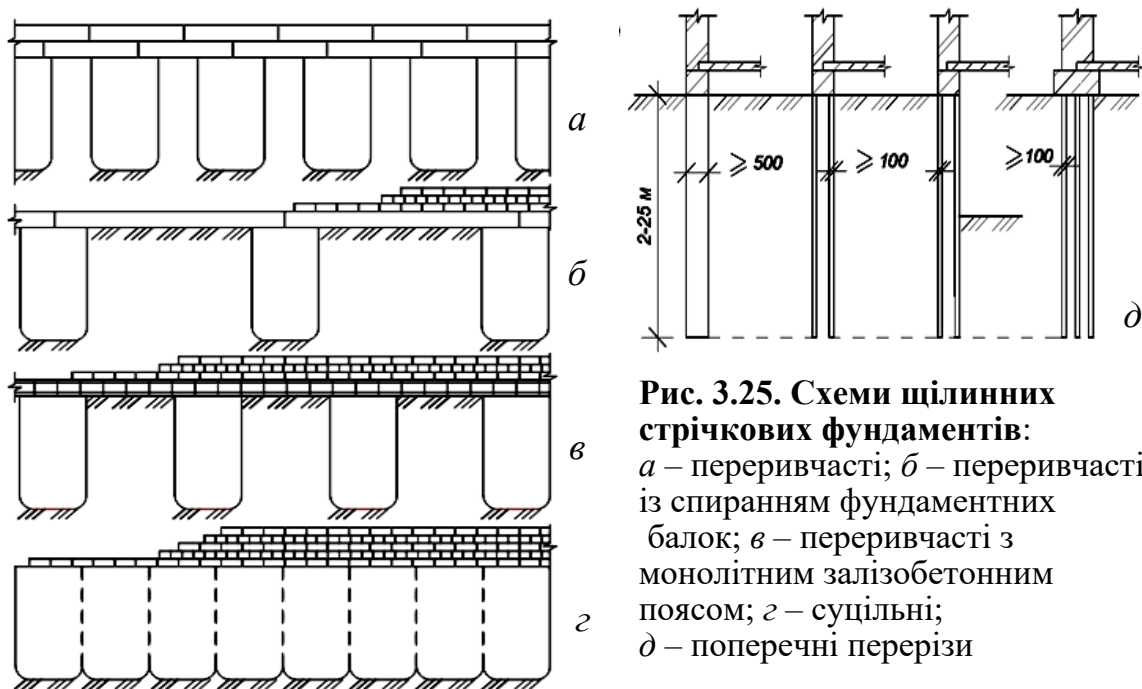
Схеми щілинних стрічкових фундаментів:
